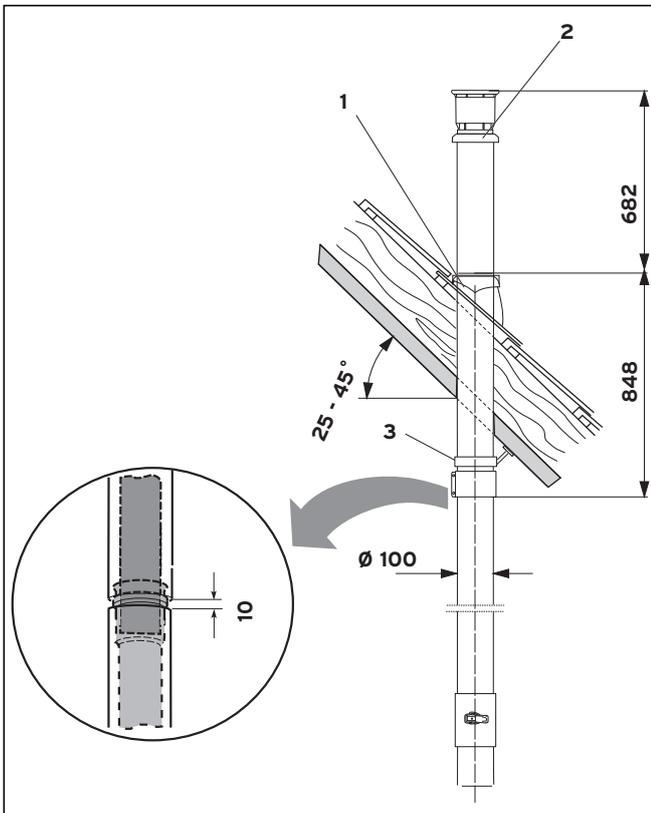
Montagebeispiel: Senkrechte Dachdurchführung
